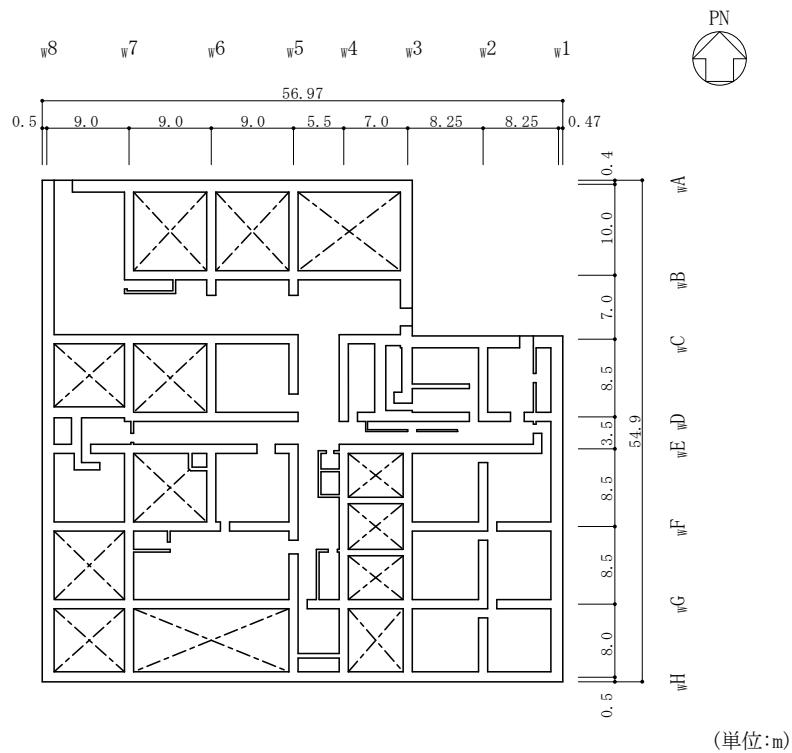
(2) 廃棄物処理建物の概略平面図 (EL 8.8m)
